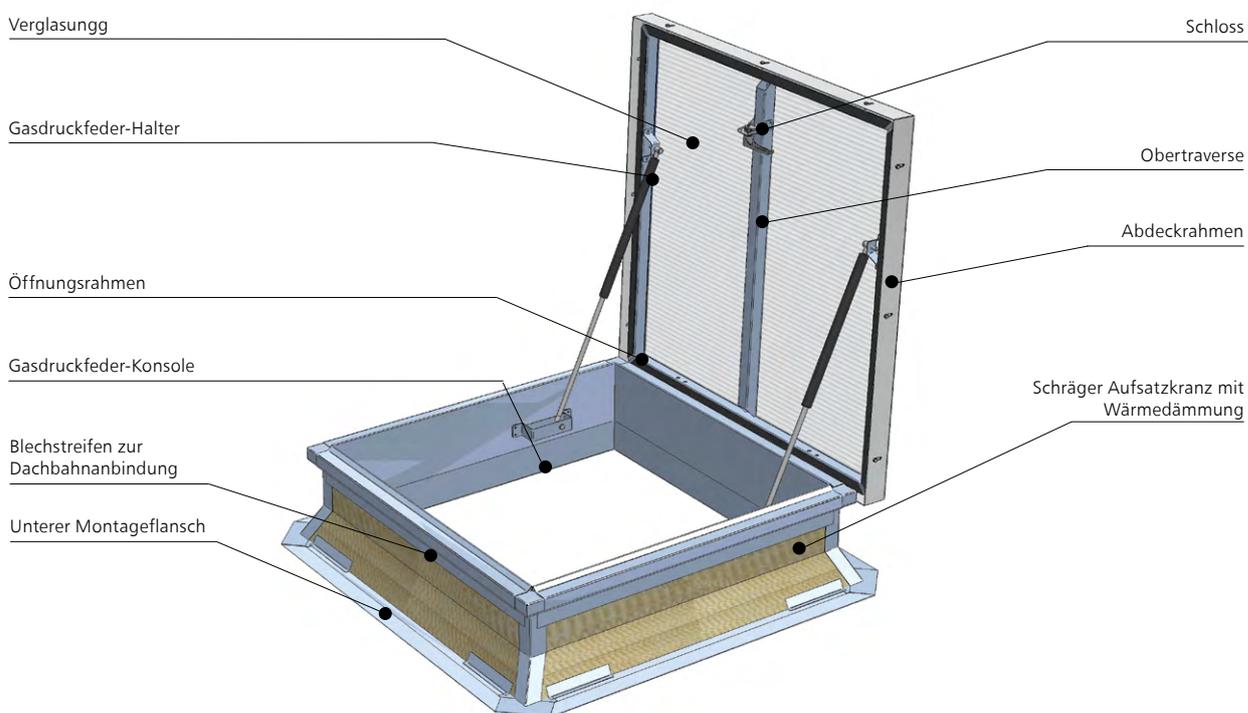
Aufbau des Dachausstiegs mcr PROLIGHT NG-A
